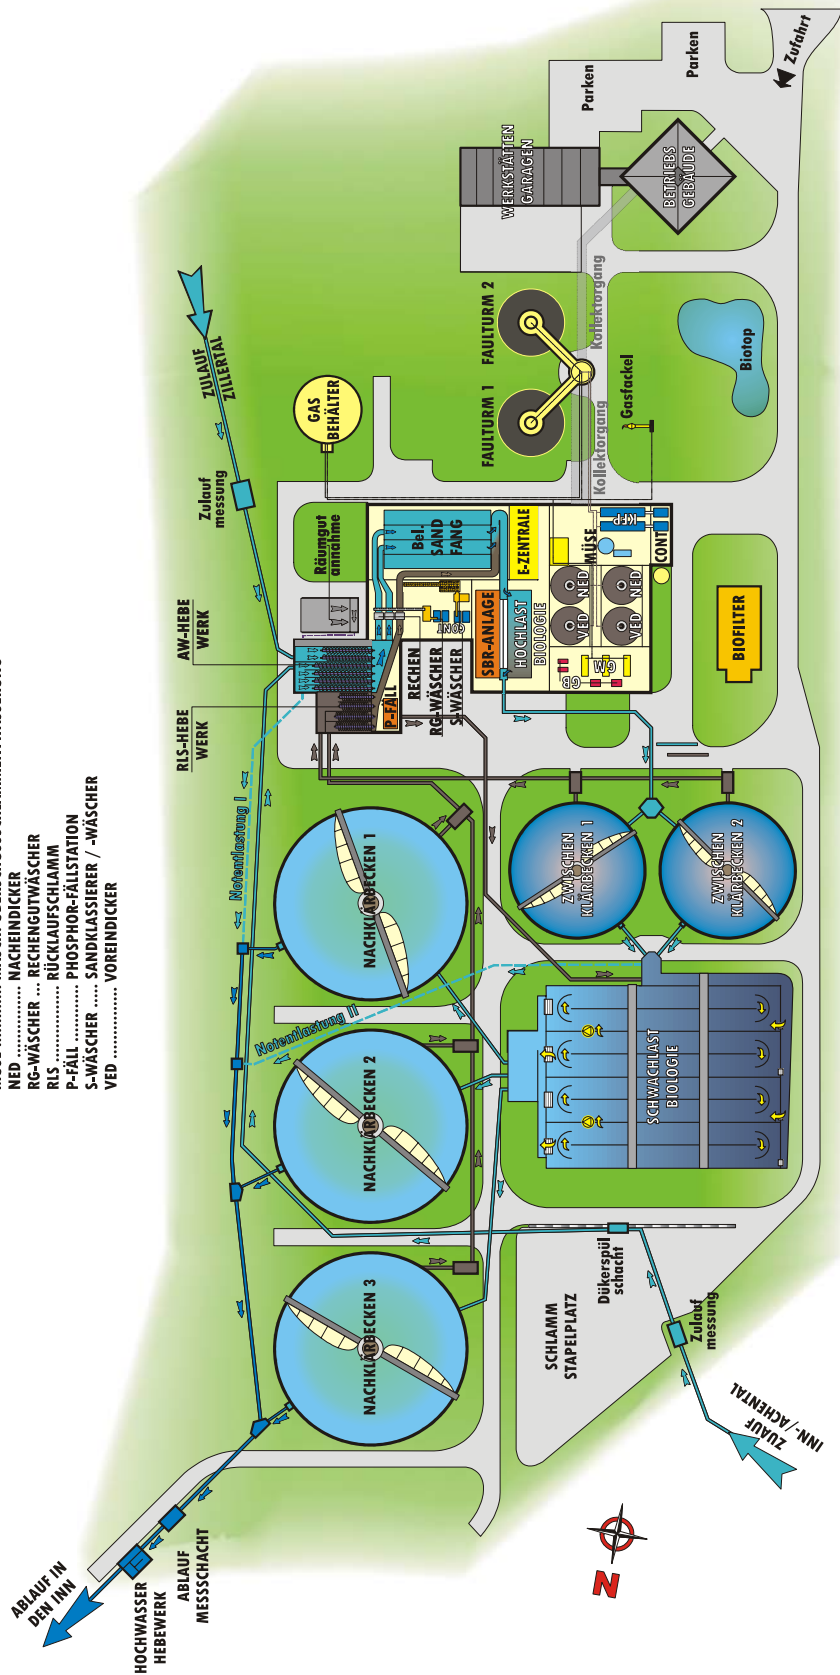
Lageplan der ARA-Strass Maßstab 1:1500 (verkleinert)
